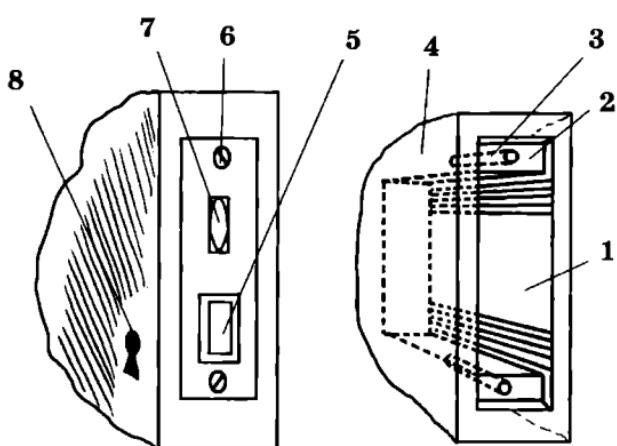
Врезка замка: 1 — паз для корпуса замка; 2 — углубление под планку замка; 3 — углубление под шурупы; 4 — массив двери; 5 — ригель; 6 — шурупы; 7 — защелка; 8 — замочная скважина
